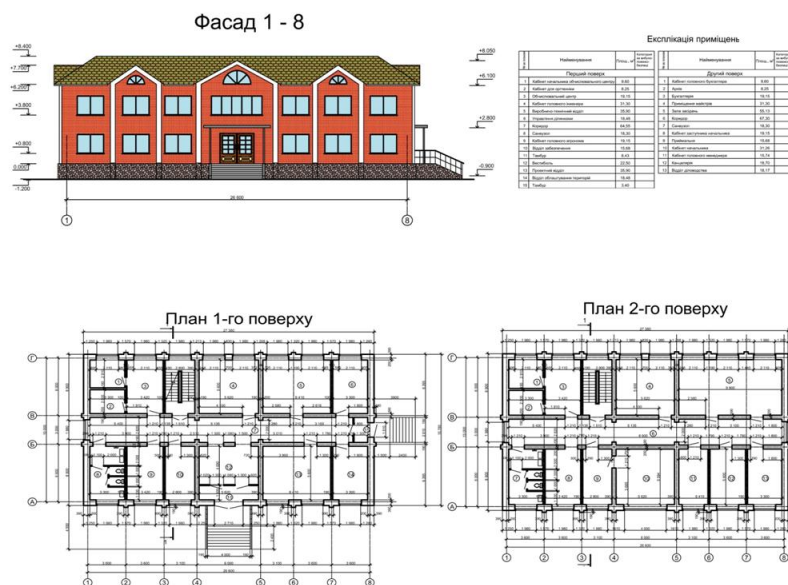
Фасад і плани поверхів адміністративної будівлі
